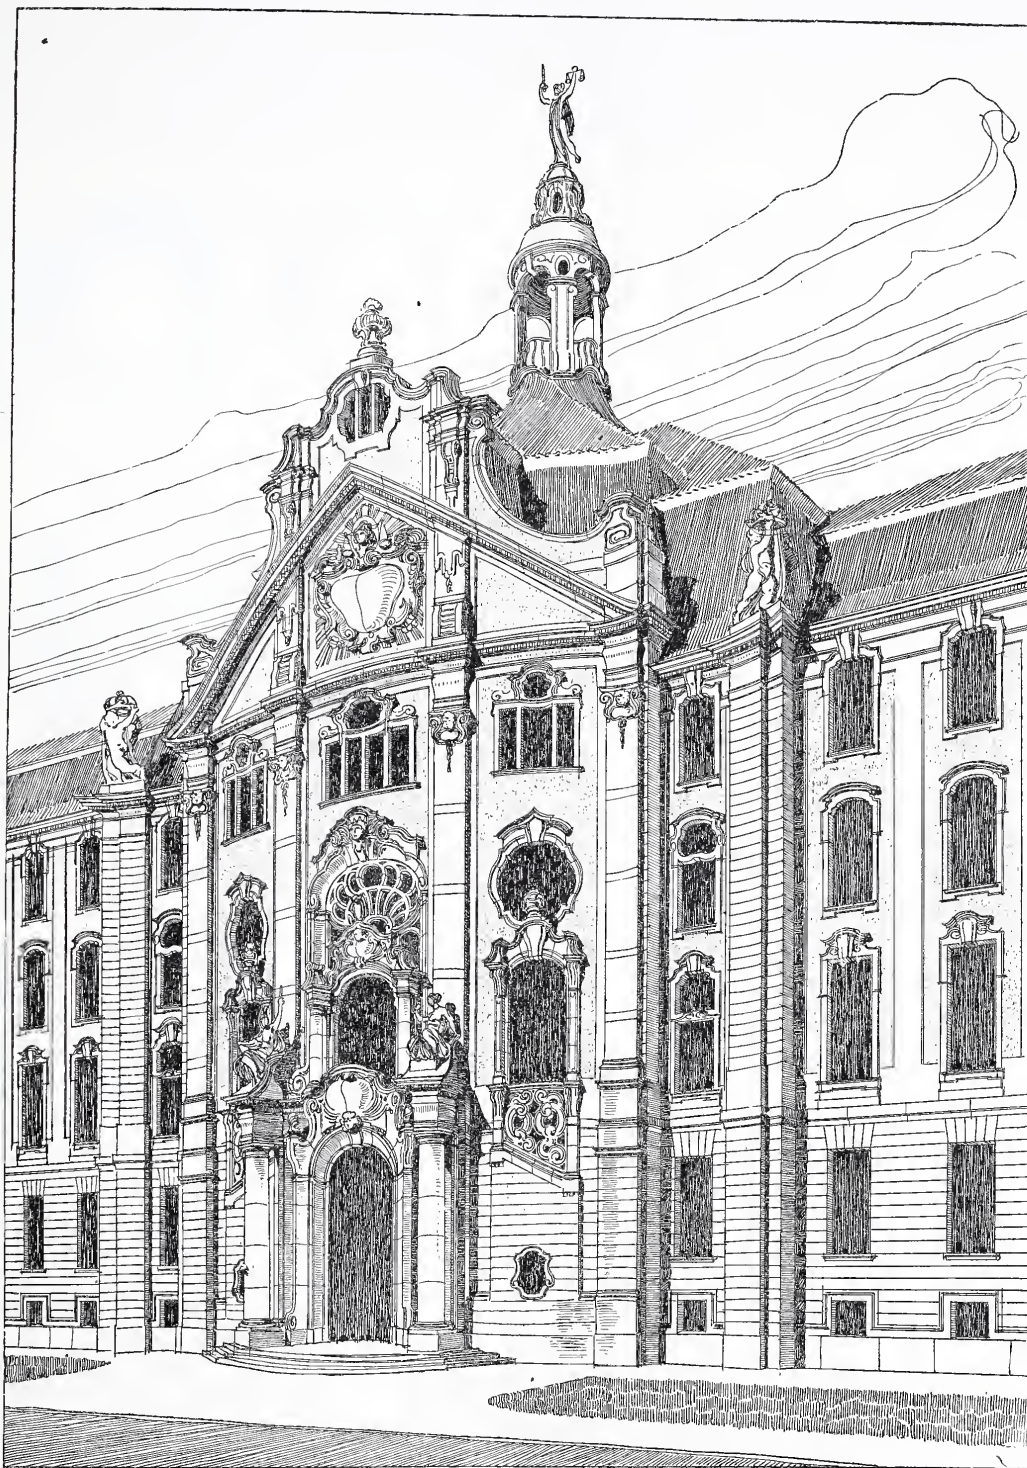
Mittelbau mit Eingang zum Haupttreppenhause.
